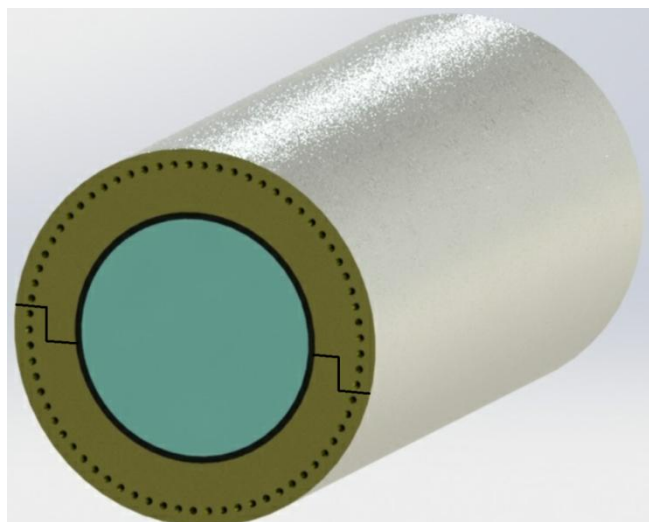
Модель теплопровода с ППУ теплоизоляцией и воздушными прослойками
